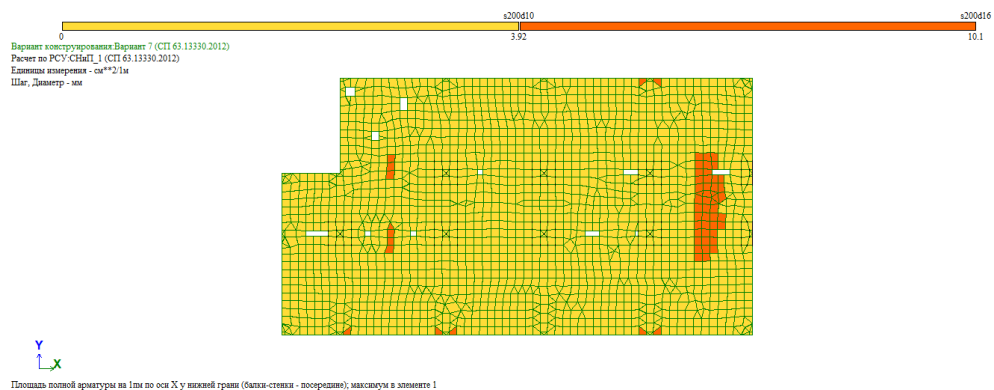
Армирование нижней зоны монолитной плиты по оси X
